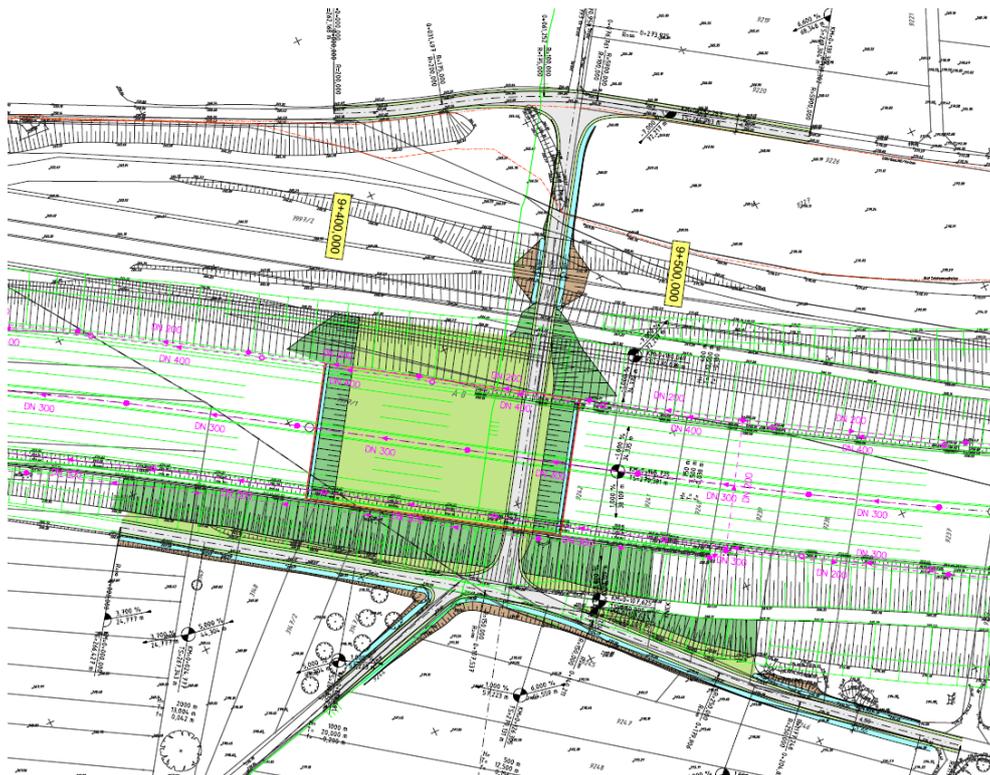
Ausschnitt aus dem Lageplan zu Variante 2
